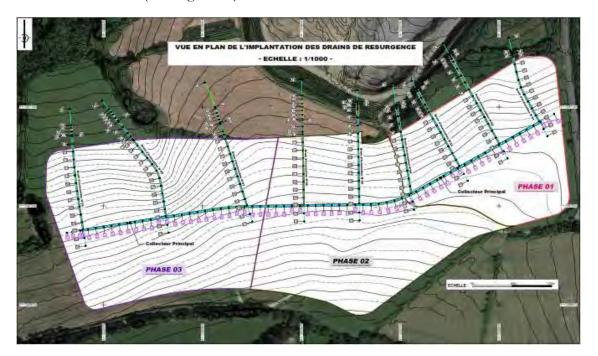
Vue en plan du dispositif de drainage des résurgences
